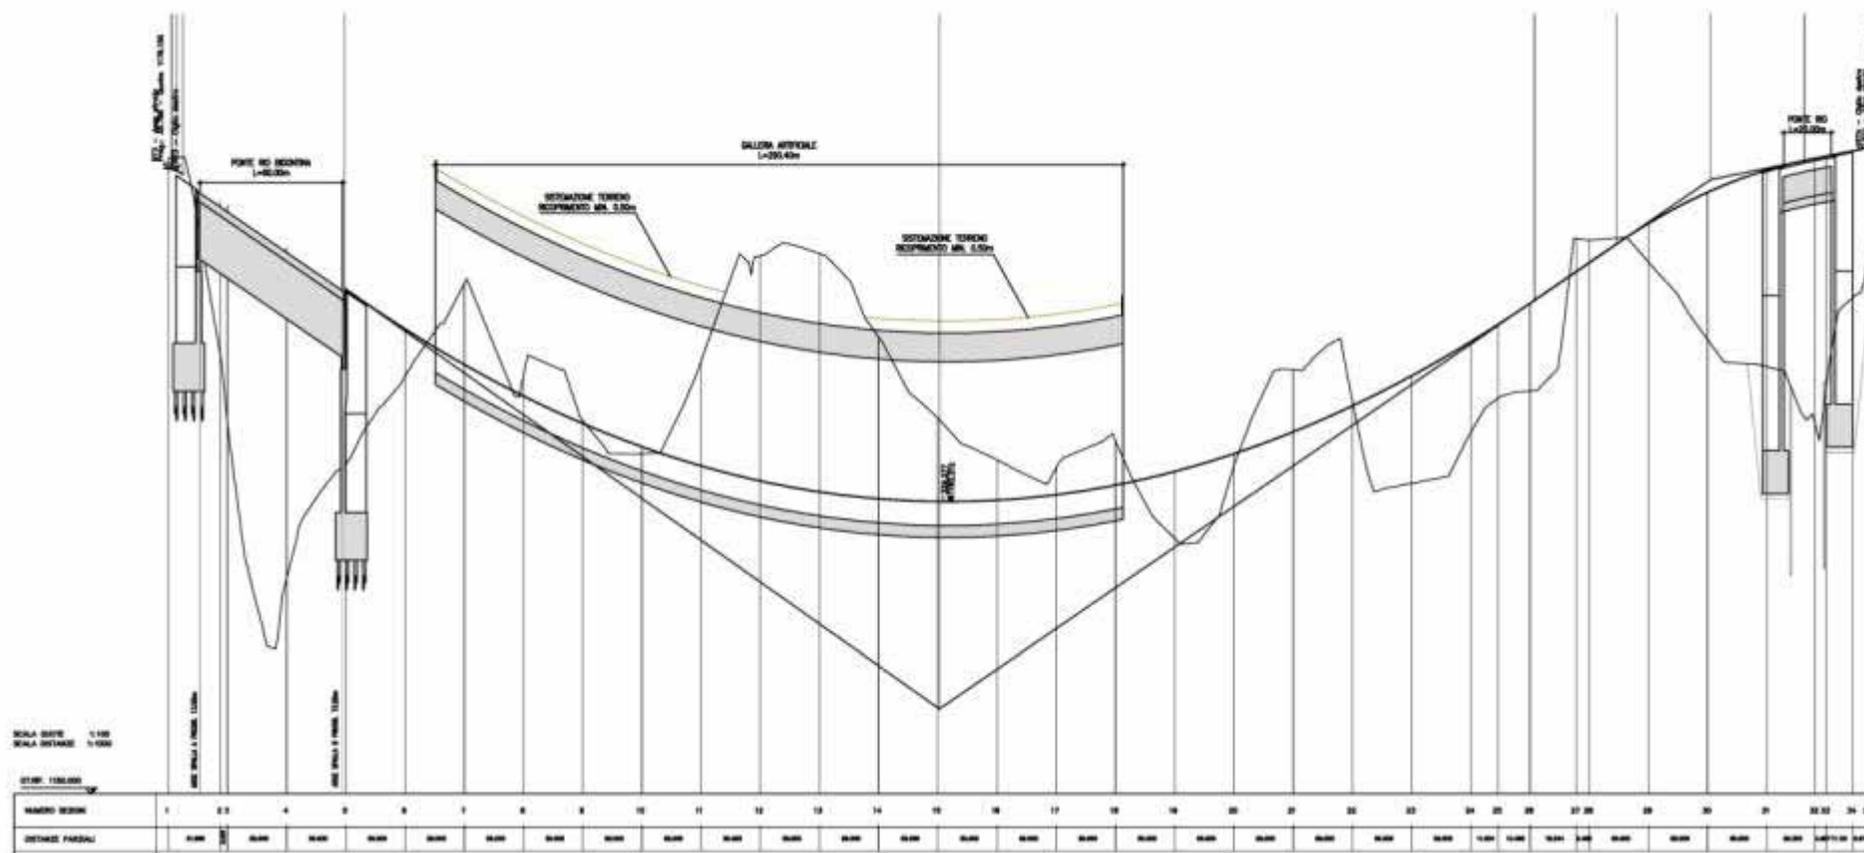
Profilo (ns. elaborazione da tavola P01PS00TRASZ01\_A\_Asse principale - Sezioni trasversali del progetto definitivo).
